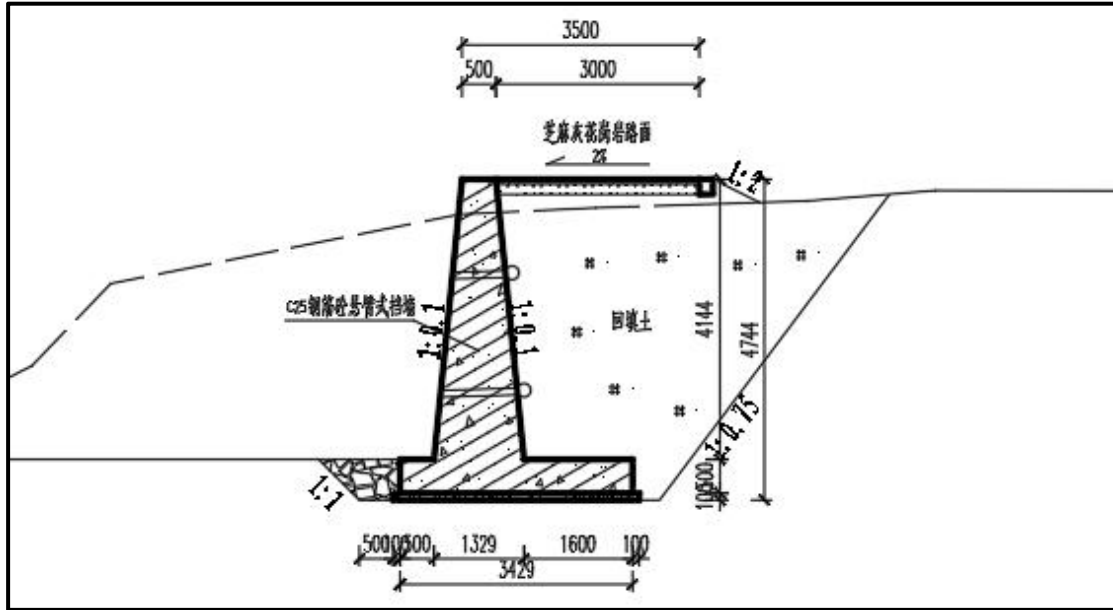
方案三钢筋砼式墙式护岸断面图
